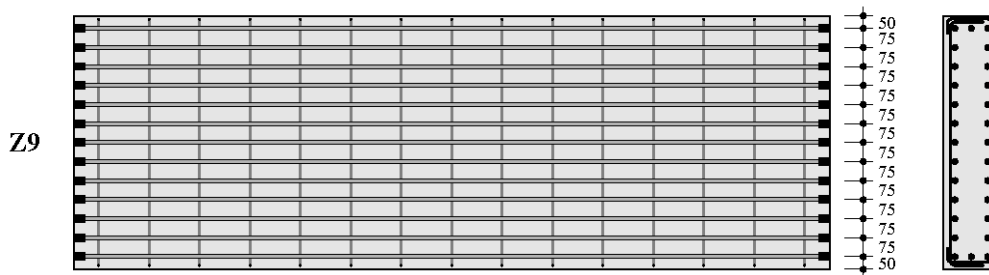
Bewehrungsführung des Versuchskörpers Z9 (aus [2])
